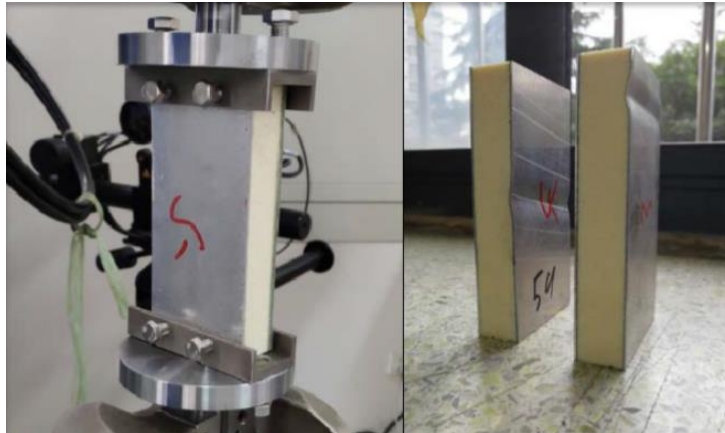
Configuração do ensaio de compressão lateral e modo de falha de estruturas testadas [62]
